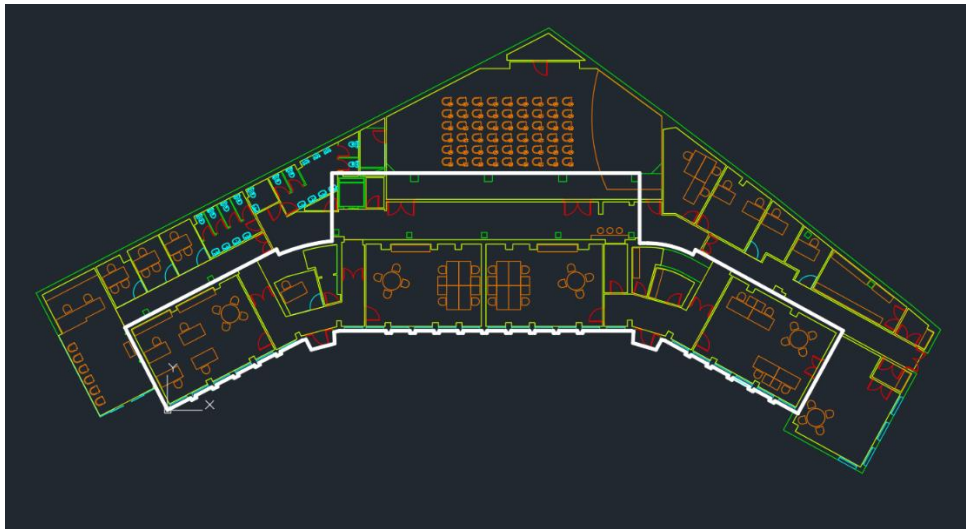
Diferencia de forma entre la planta baja del edificio y las demás plantas
